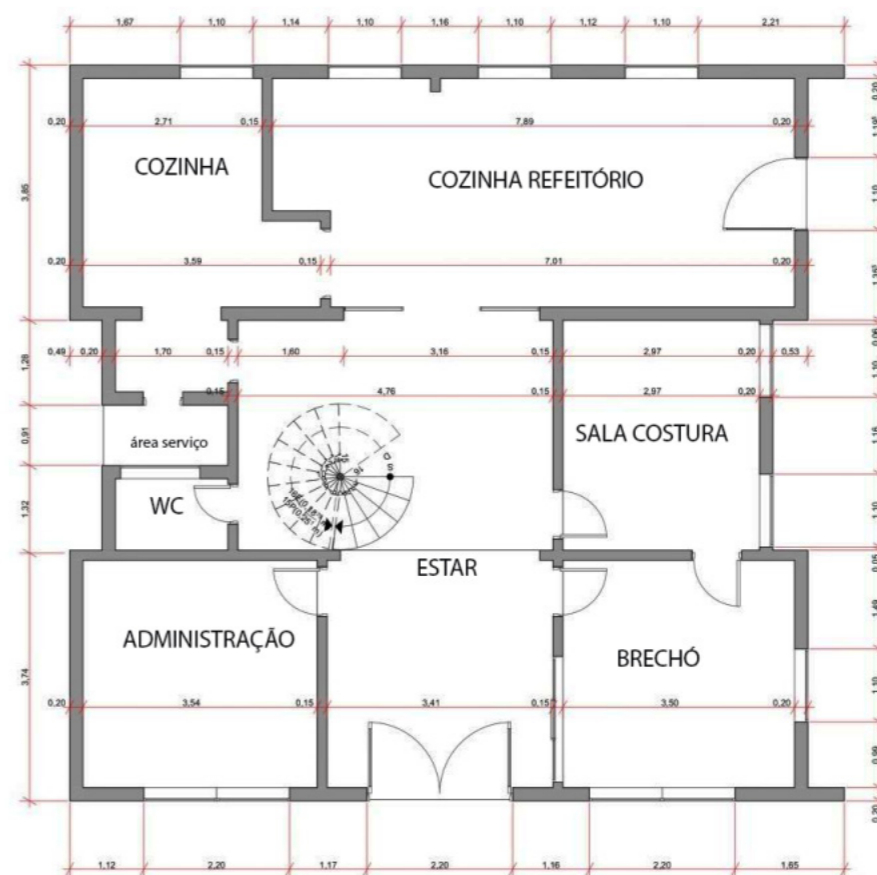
Planta baixa. Casa e Administração. Dos autores. Figura 11 - Pavimento superior. Casa e Administração. Dos autores.
